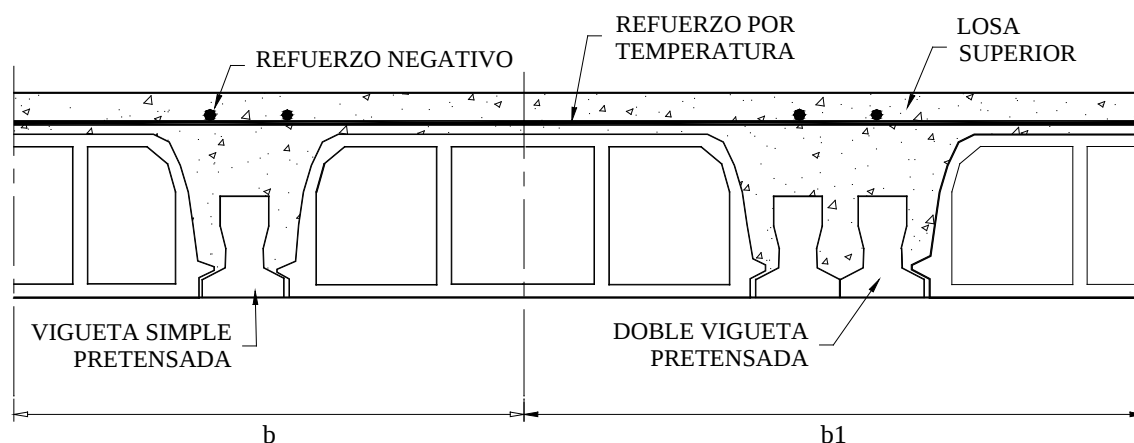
Sección típica del sistema de losa con viguetas pretensadas.
